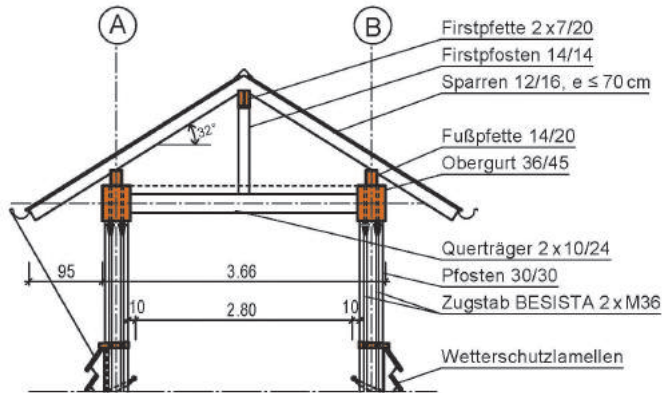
Detailbetrachtung der Dachkonstruktion als konstruktiver Holzschutz für die Obergurtebene des Haupttragwerks
